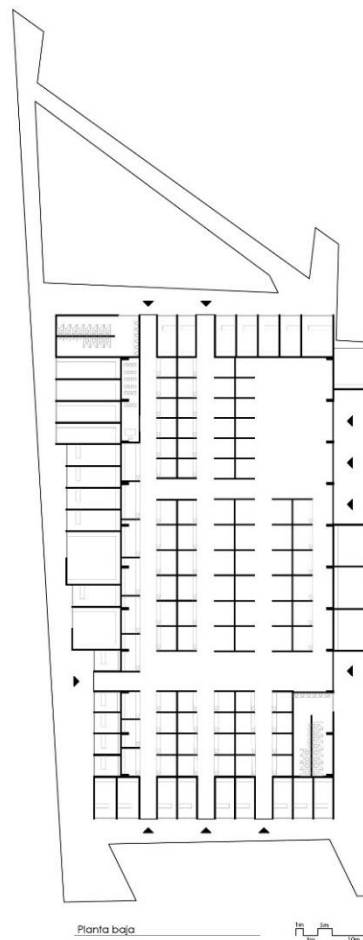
Planta baja Mercado Sur. Elaboración propia (2023).
